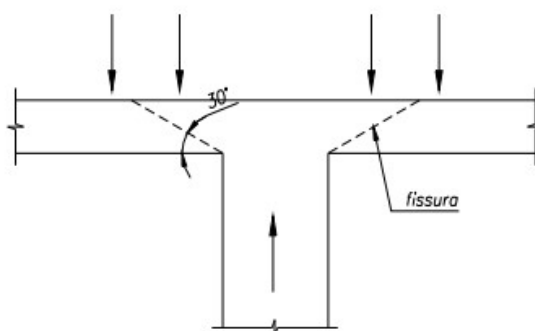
Zona de ruptura em lajes submetidas à punção sem armadura de cisalhamento.
